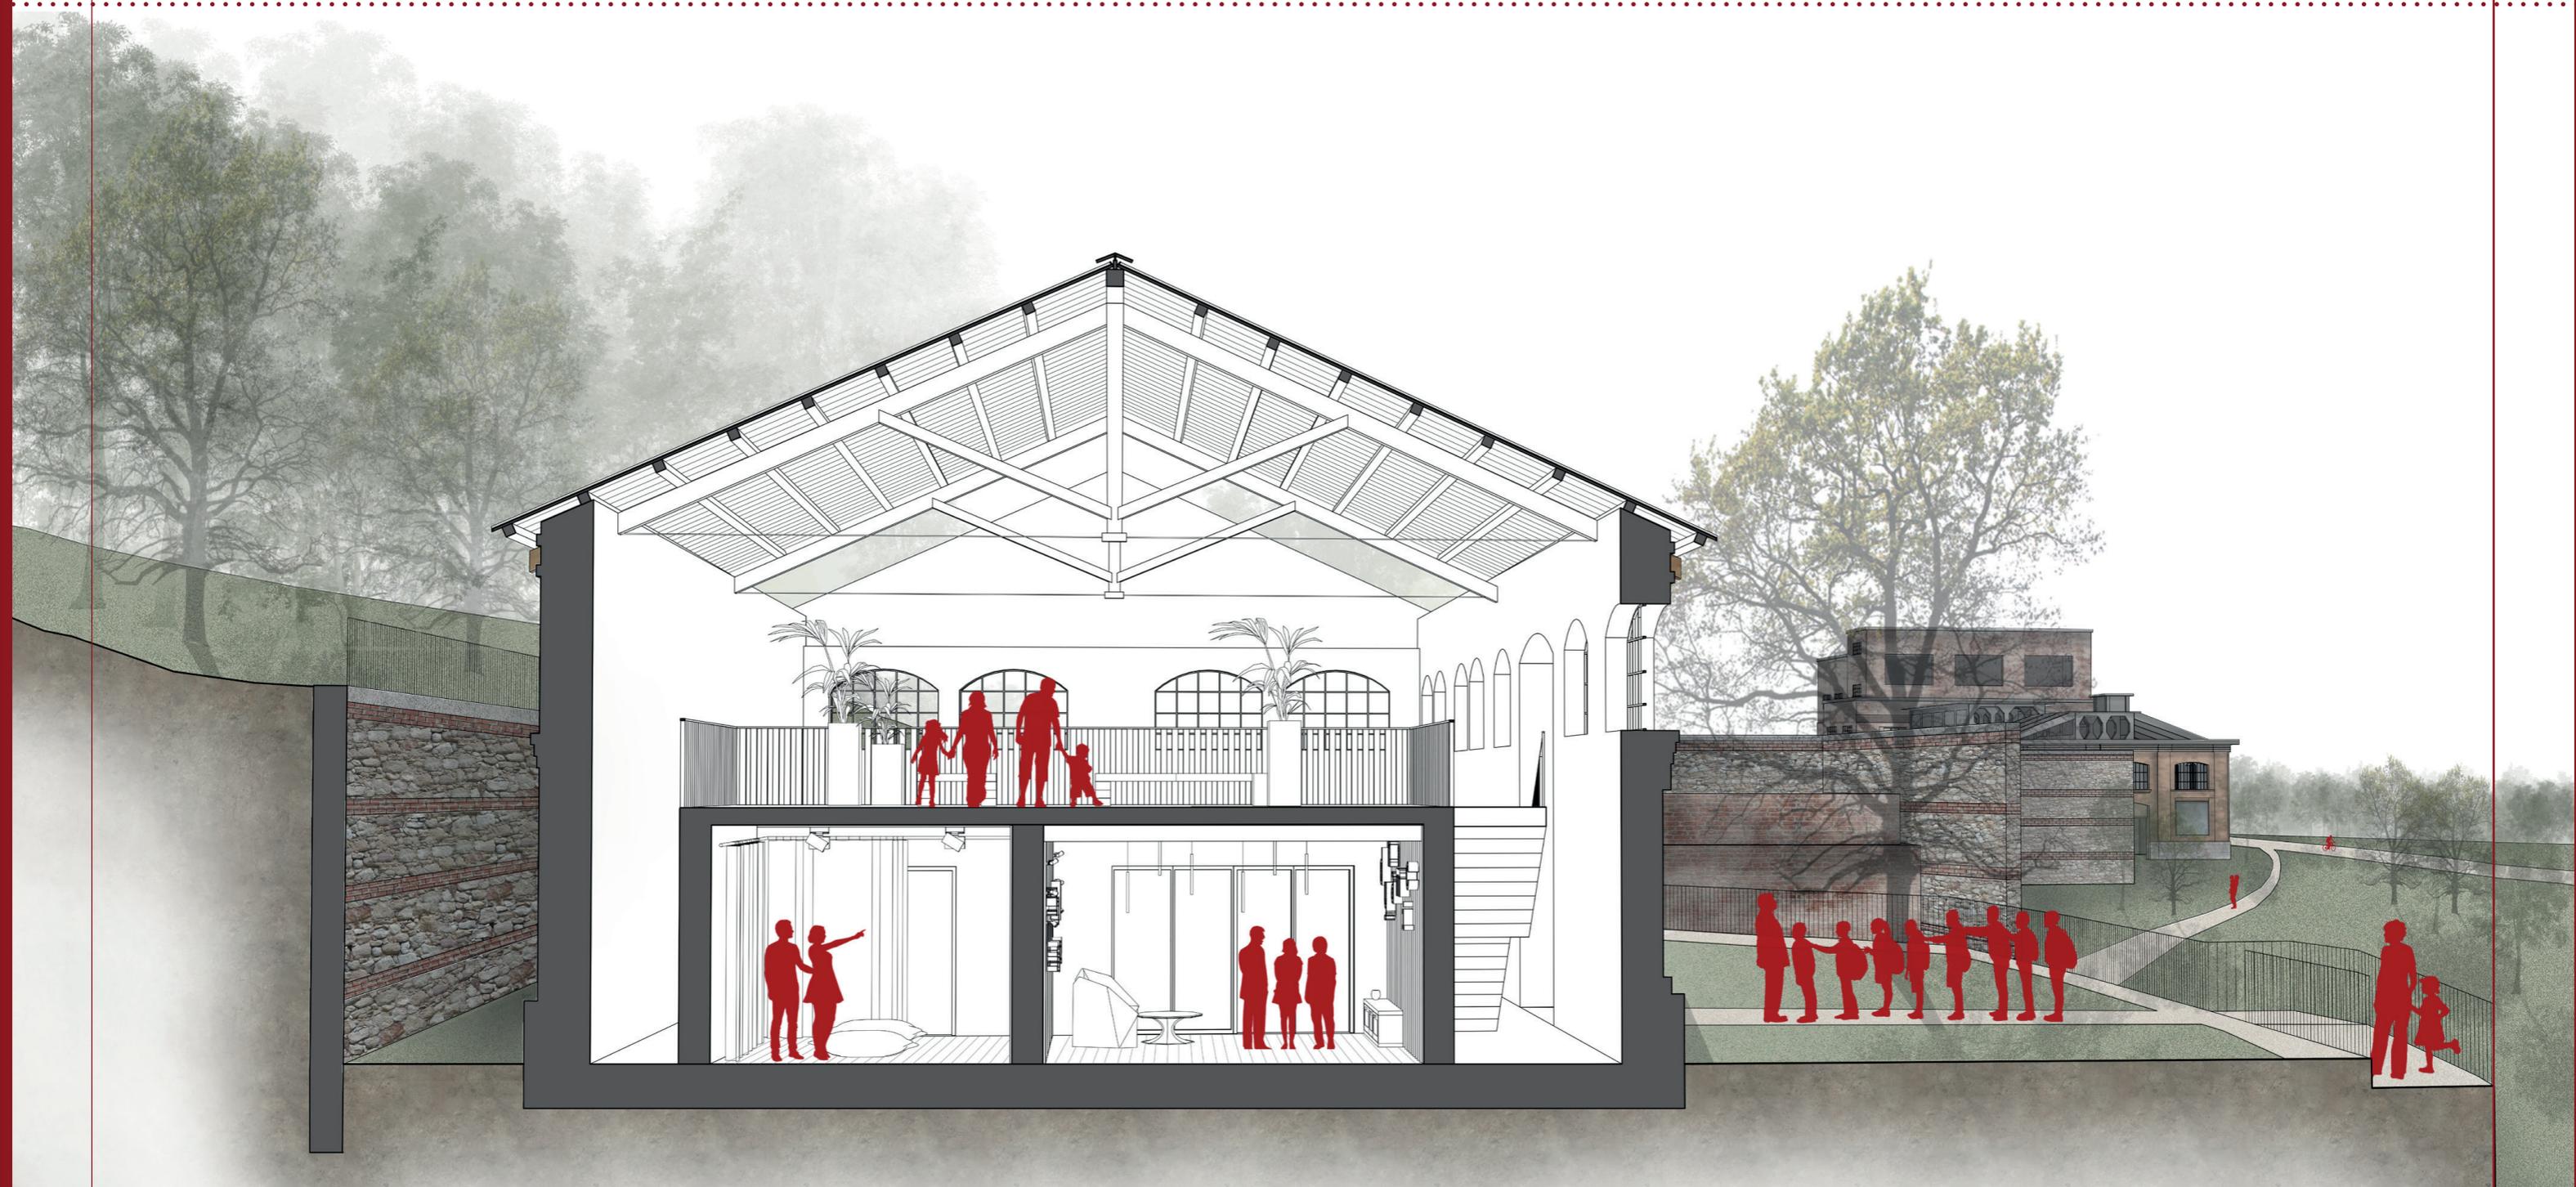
Sezione prospettica del polo centrale dell'escape room, fuori scala, elaborazione delle autrici
